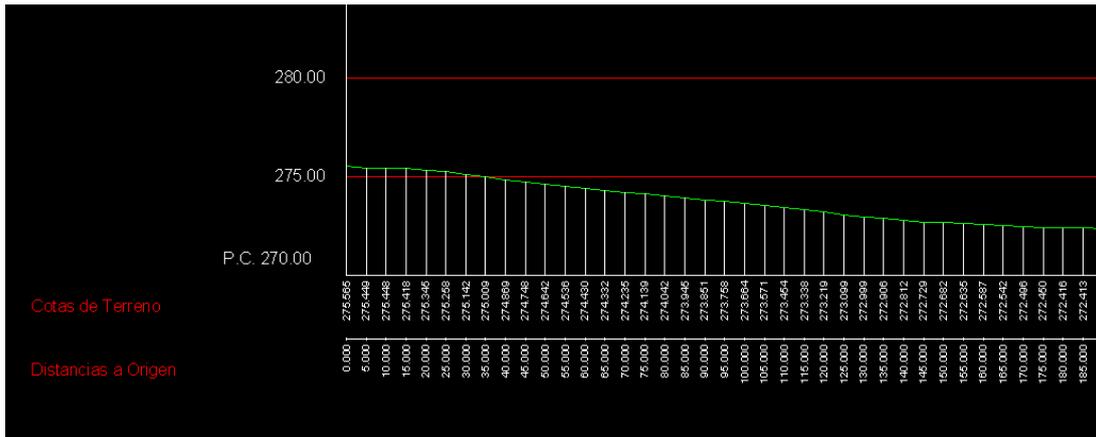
Tramo perfil longitudinal acceso planta fotovoltaica
